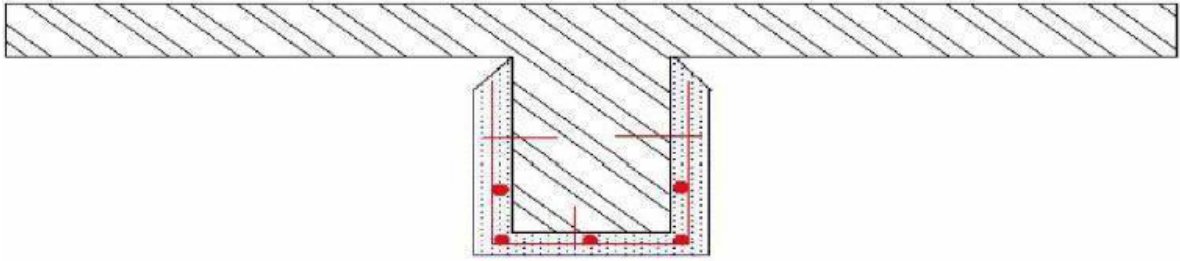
Renforcement d'une poutre par chemisage [2].
